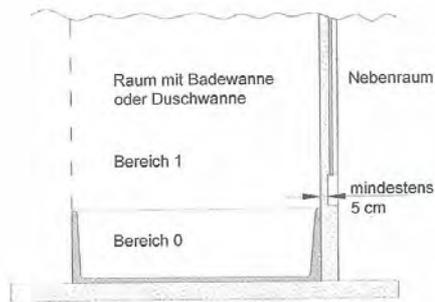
Mindest-Restwanddicke in den Begrenzungswänden der Bereiche 1 und 2
